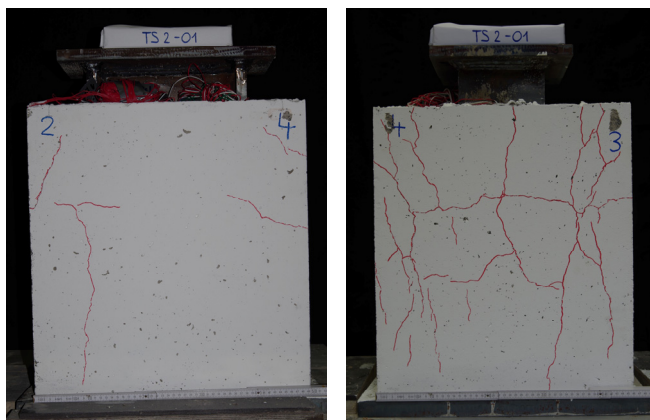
Darstellung der Rissbildung im Prüfkörper TS 2-1
